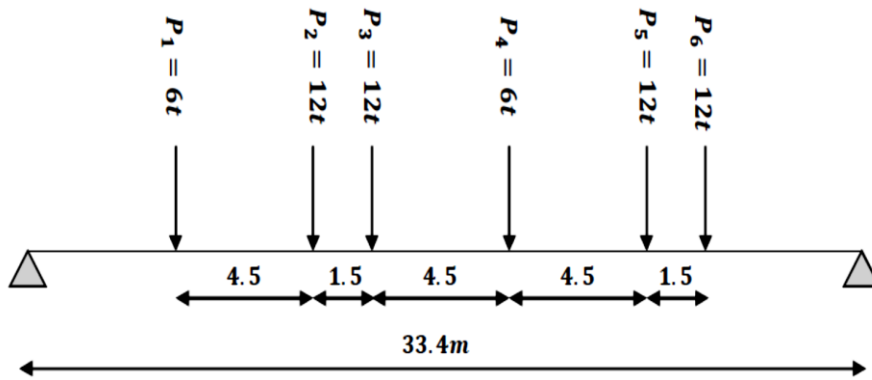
Figure V-IV : système « Bc » disposition de deux camions sur la chaussée
